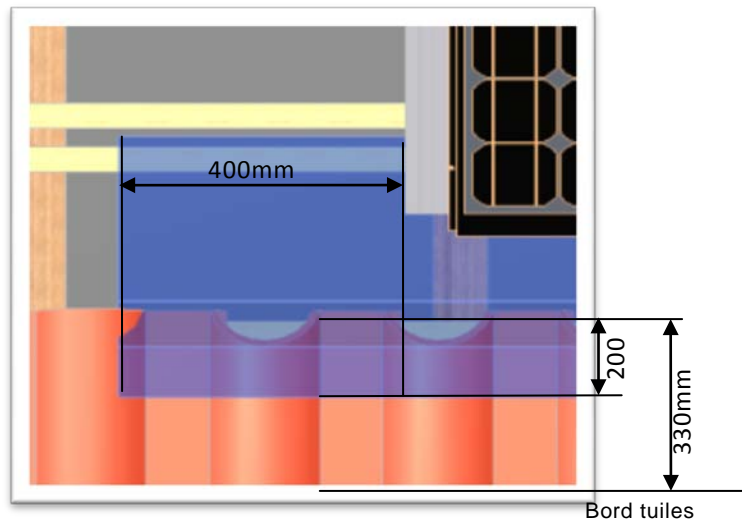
Planification horizontale de la bande d'étanchéité inférieure
